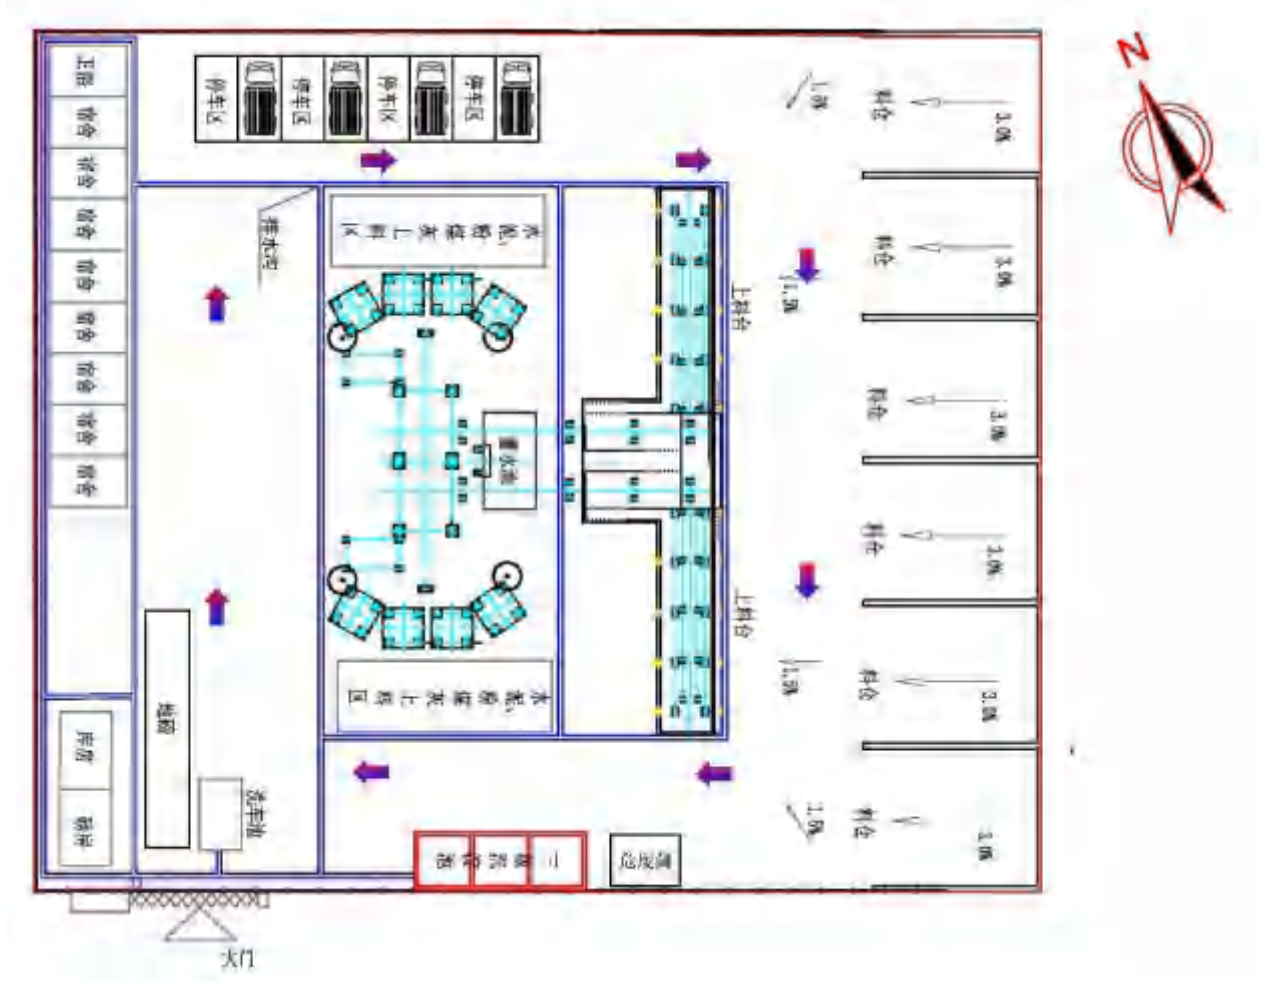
1 号施工场地（赛岐侧拌合站）平面布置图
